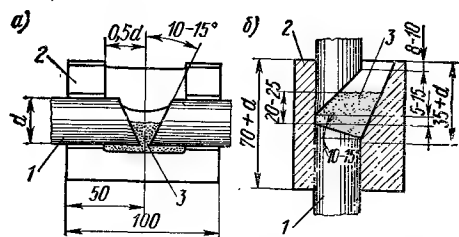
Стыки арматурных стержней подготовленных для полуавтоматической электрошлаковой сварки:
